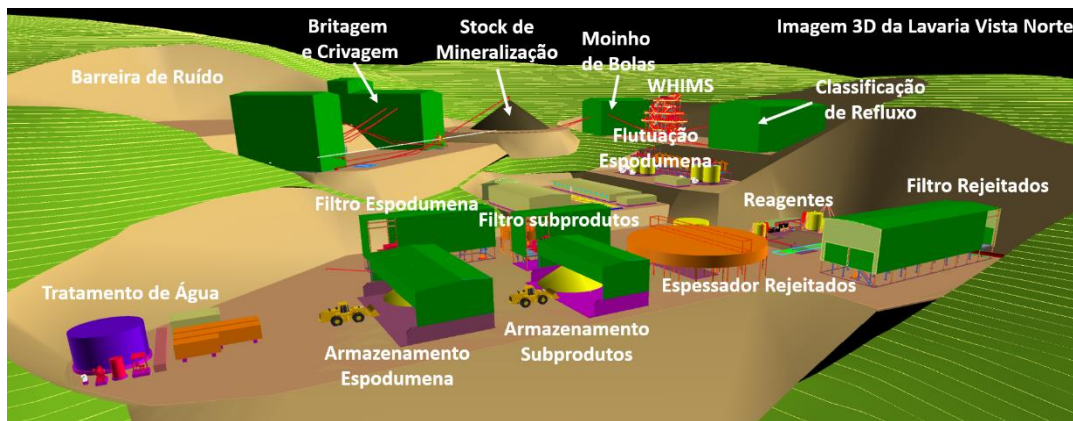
Imagem 3D da unidade de processamento vista para Norte (no local da opção 2).
